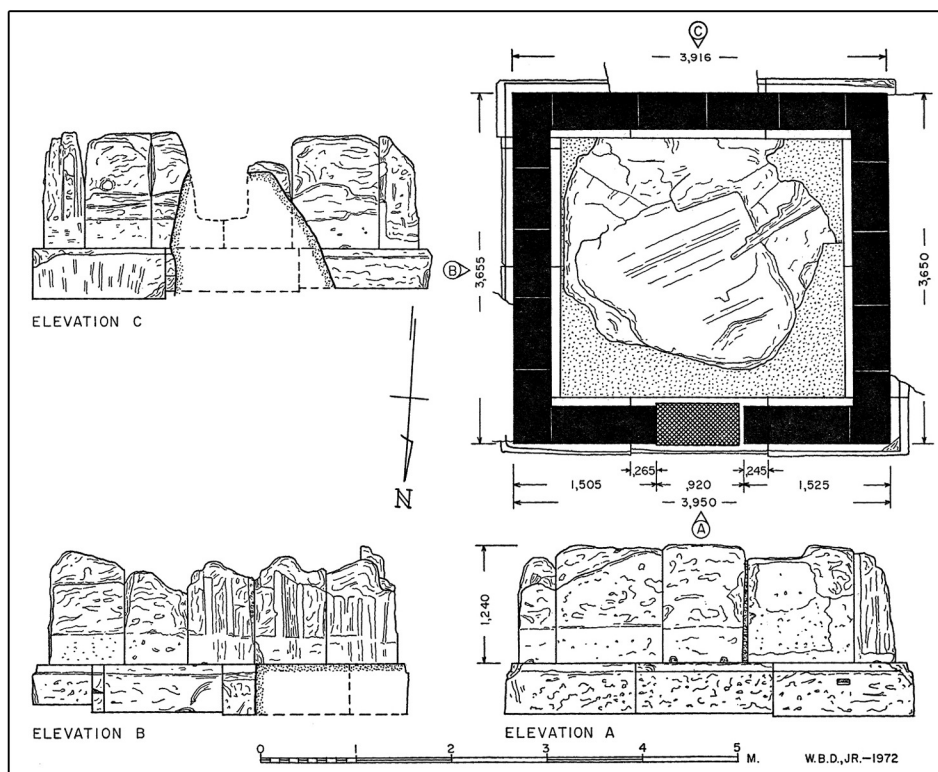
Pianta e elevato del recinto dell'incrocio
